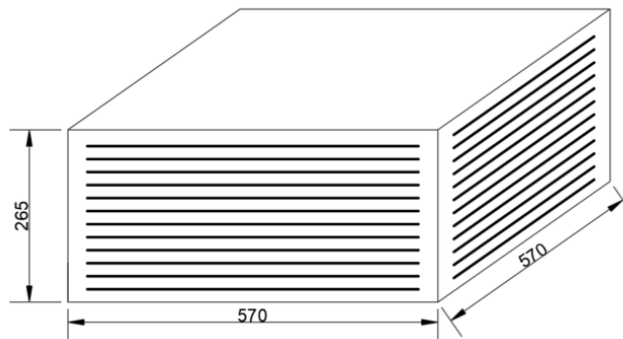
Elastómero tipo 60° Shore A perteneciente a estribos (dimensiones en mm).
